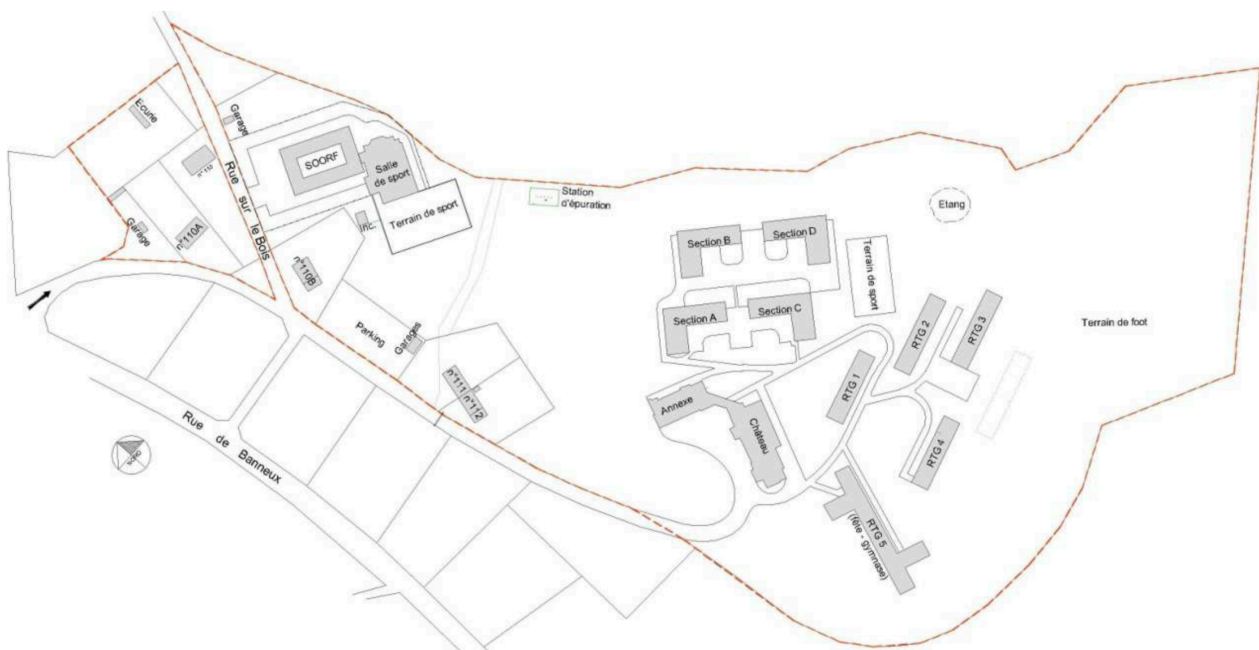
Plan d'implantation de l'IPPJ de Fraipont
